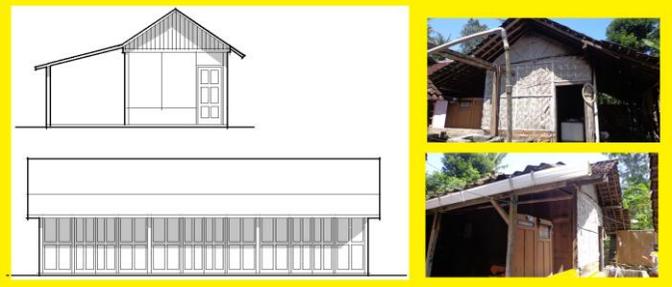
d. Rumah Bapak Sudiyono, wujud bangunan dengan ketinggian kolom bangunan 3m
